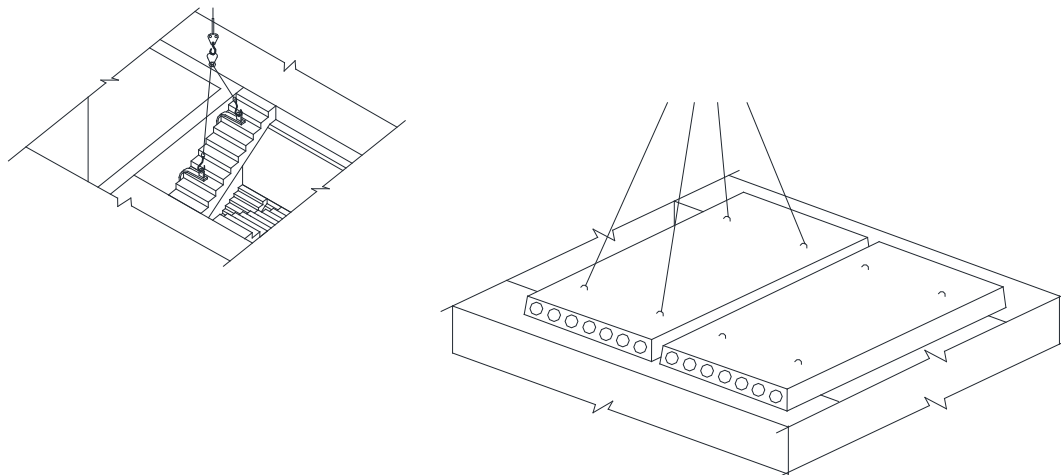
Монтаж лестничных маршей и плит перекрытия.
